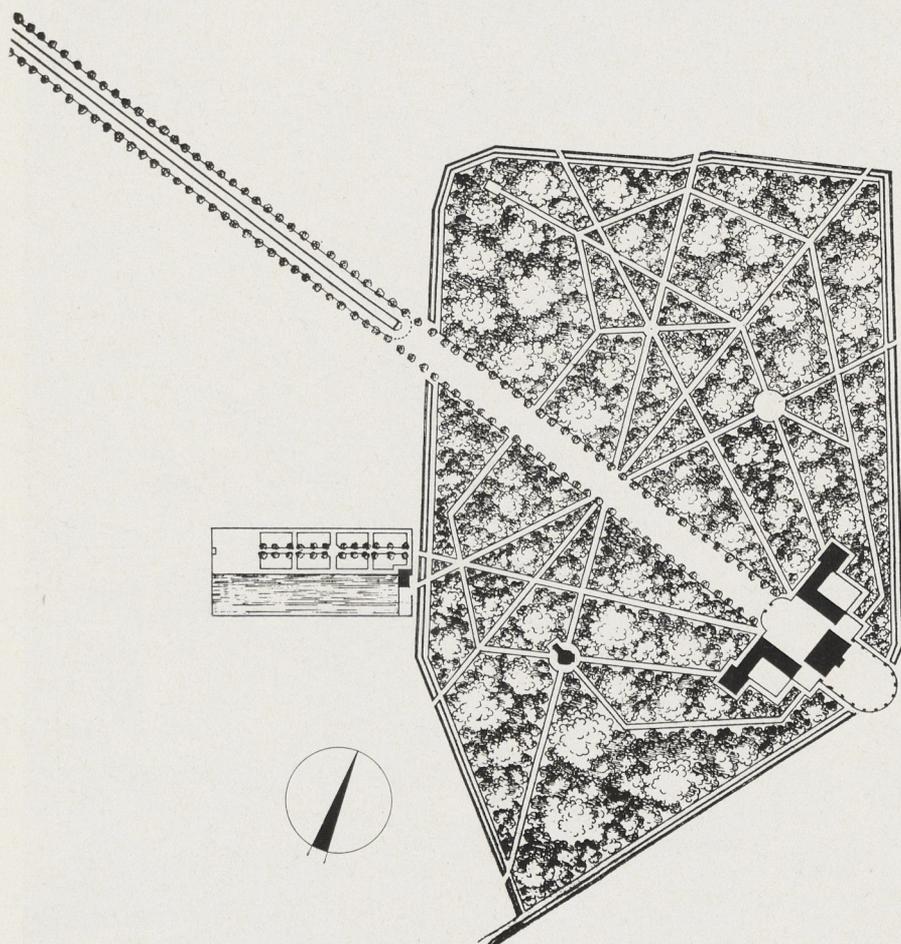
Lageplan von Schloß Falkenlust bei Brühl. Ausschnitt aus dem Girard'schen Gartenplan (XVIII. Jh.)
